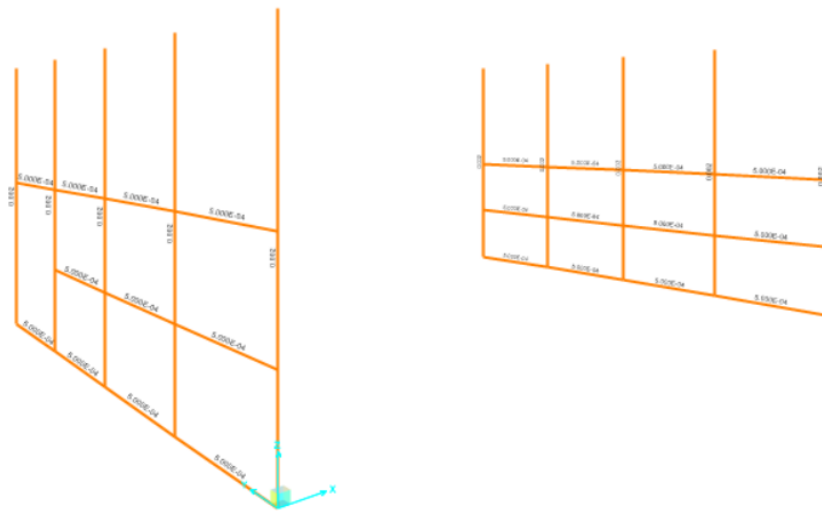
Verificación de secciones de hormigón armado en la nave industrial 2
